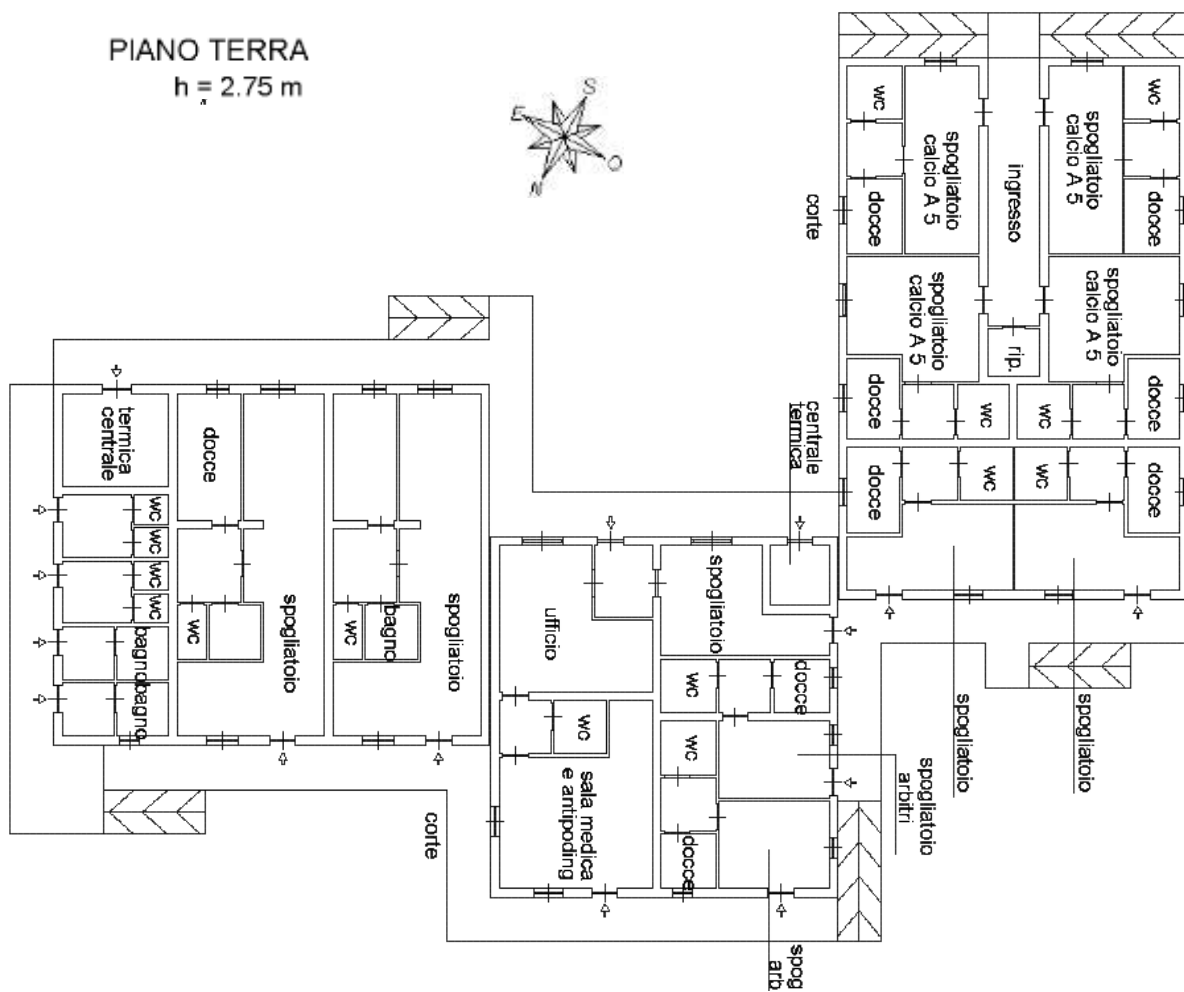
RAPPRESENTAZIONE – SU STRALCIO PLANIMETRICO – DELL'EDIFICIO A SERVIZIO DEGLI ATLETI (FONTE: INTERNA).
